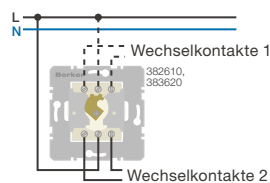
Wechselschalter 1- und 2-polig für Schließzylinder [Best.-Nr. 3826 10, 3836 20]
